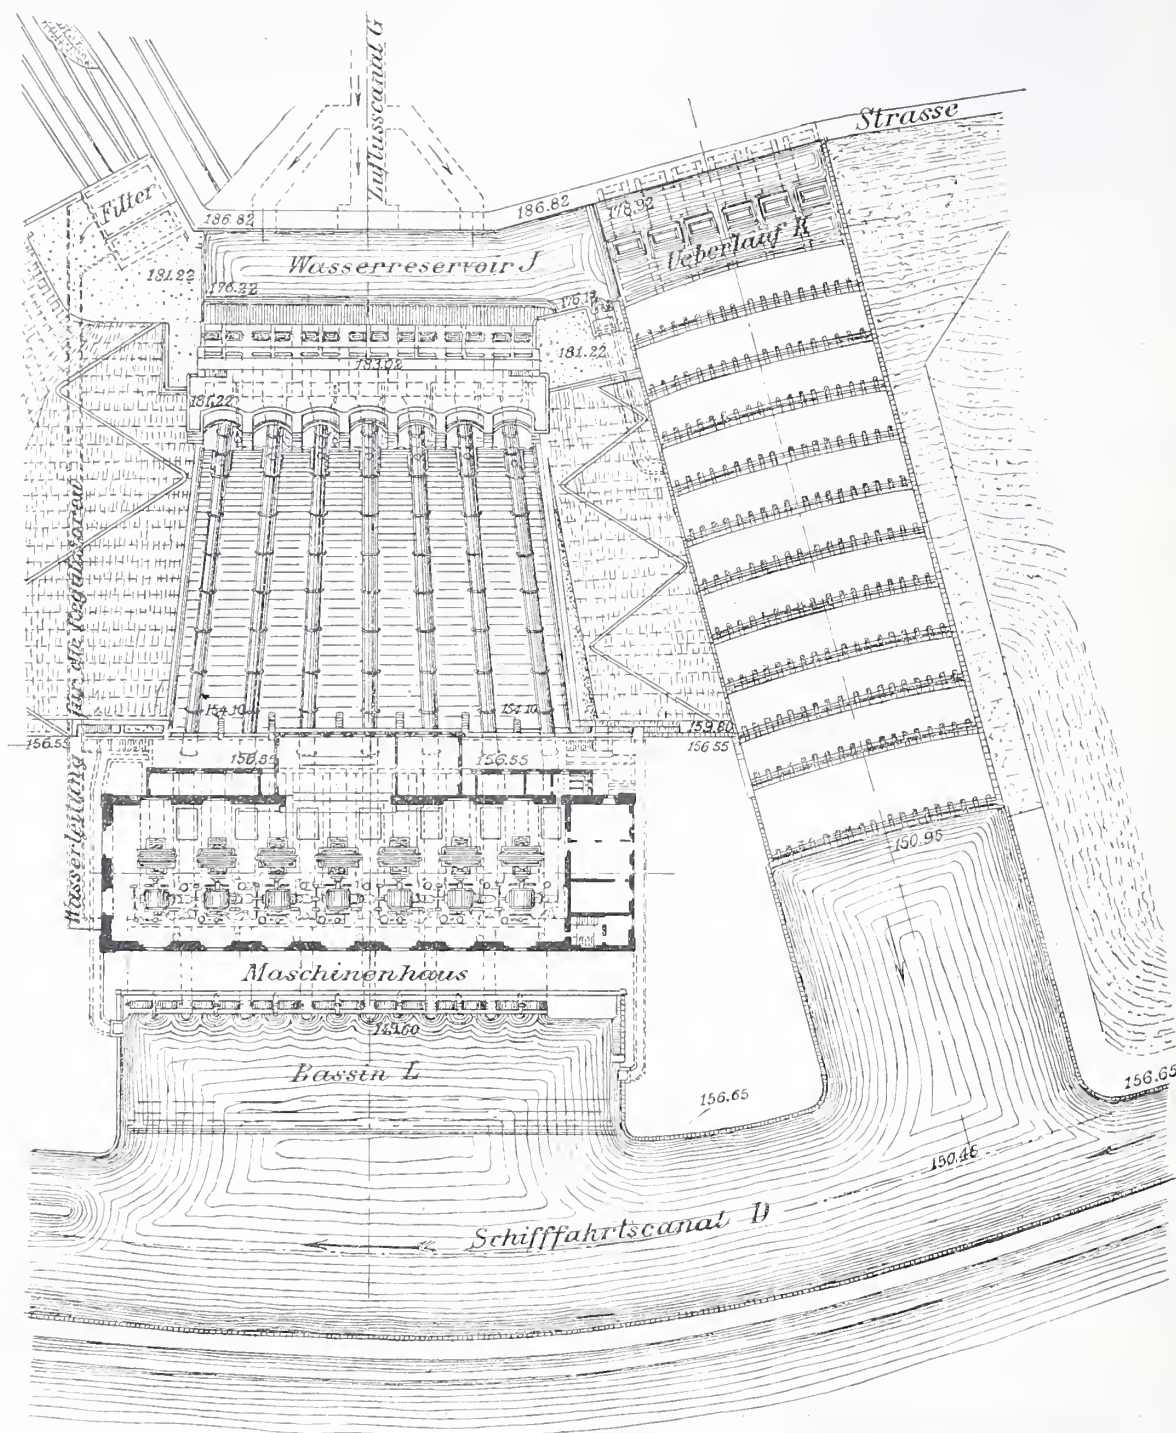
Grundriss der gesamten Turbinenanlage. 1:1000.
